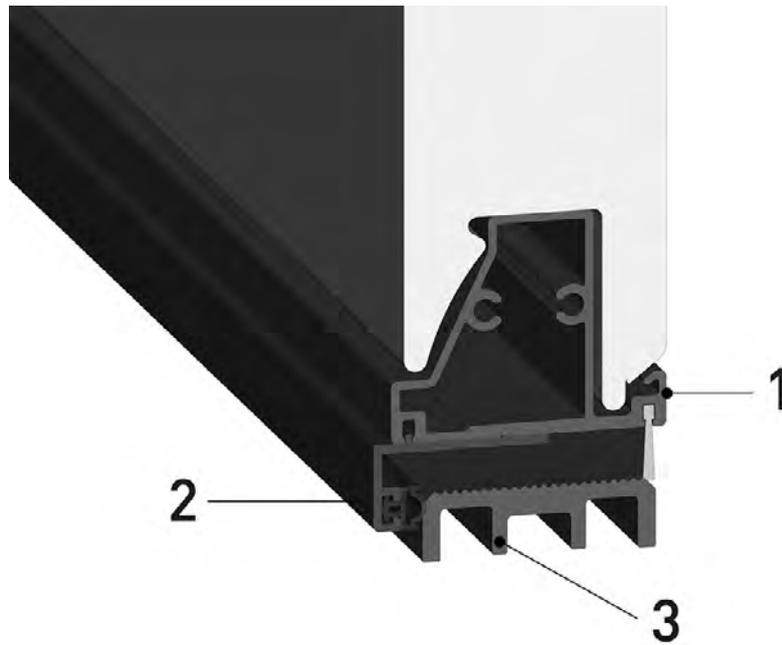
Section inférieure de la porte indépendante SDN-1 en coupe
